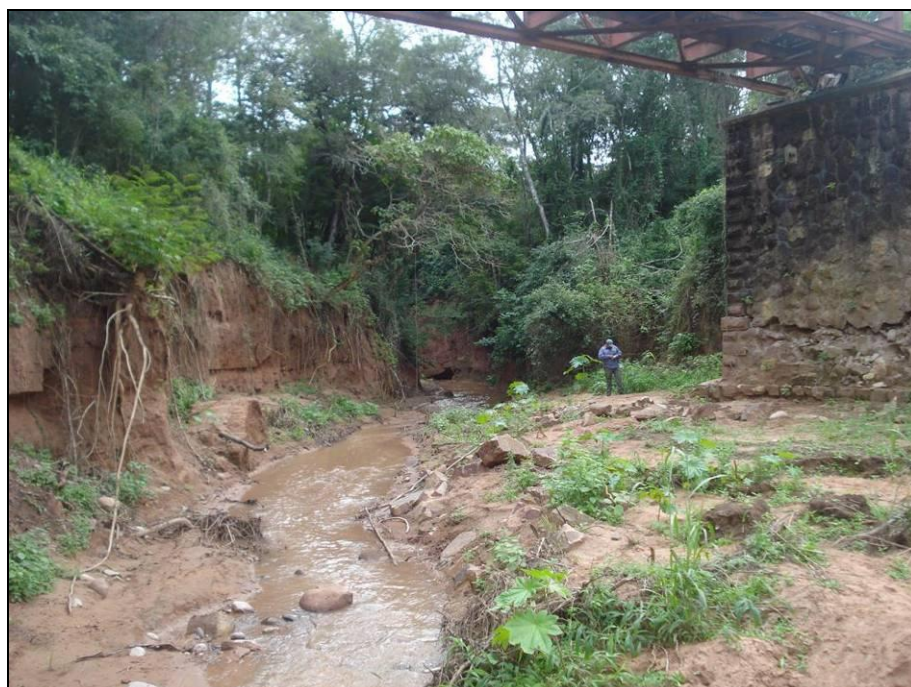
Panorama general de los estribos y el puente desde aguas abajo.
